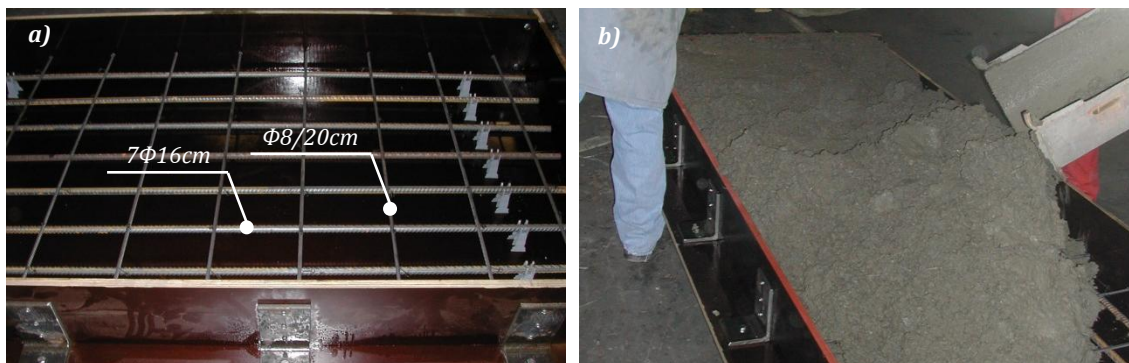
a) Armado convencional y b) hormigonado de las vigas ensayadas
